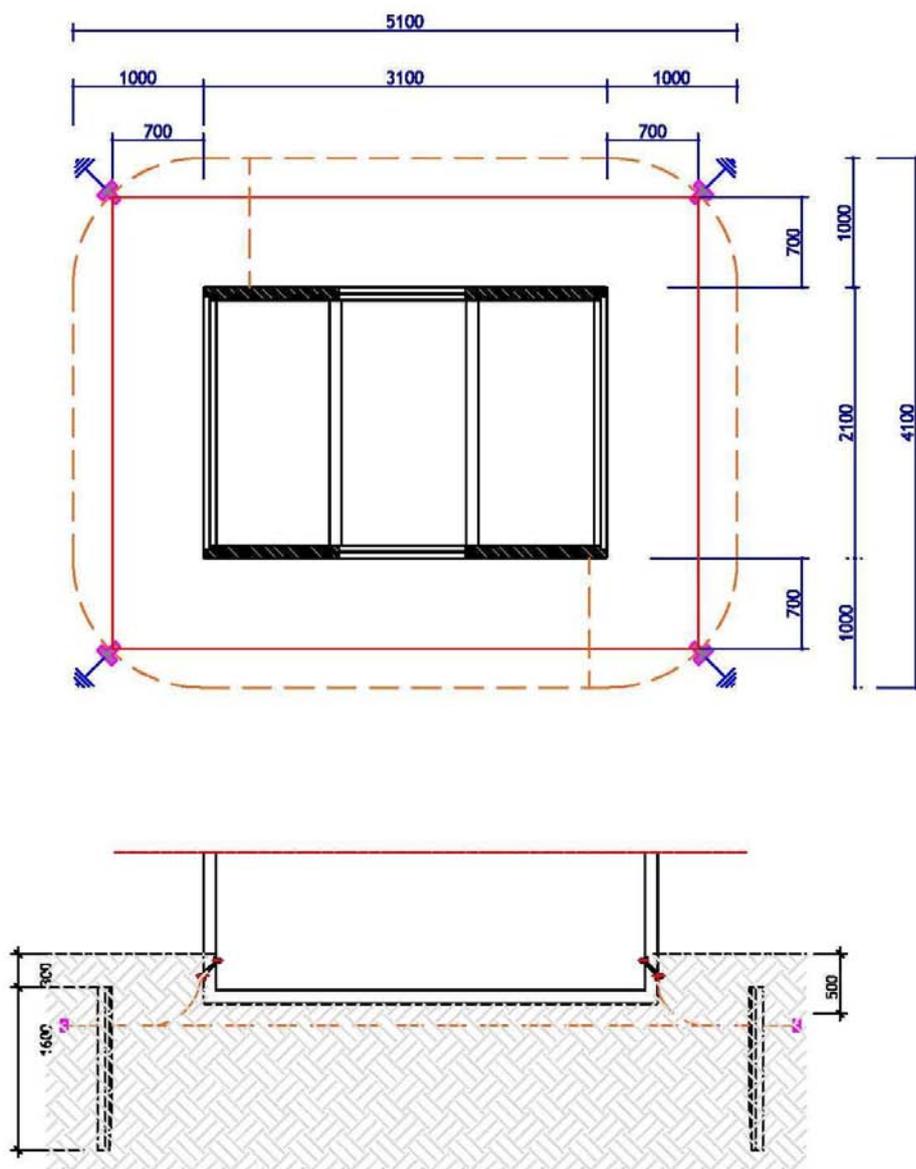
A: PARTICOLARE COLLEGAMENTO RETE INTERNA/ ESTERNA
